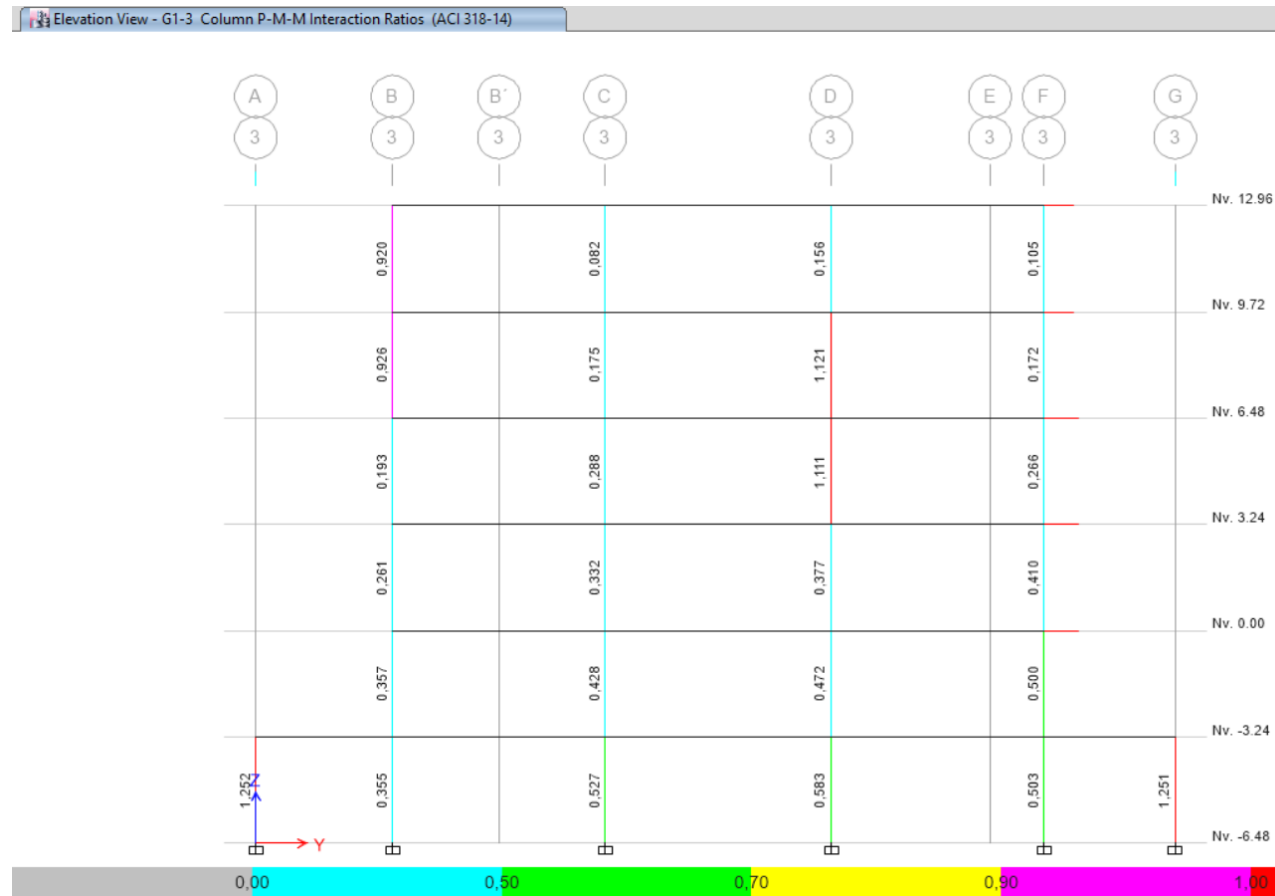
Vista en elevación de la demanda/capacidad en columnas, pórtico eje 2.
